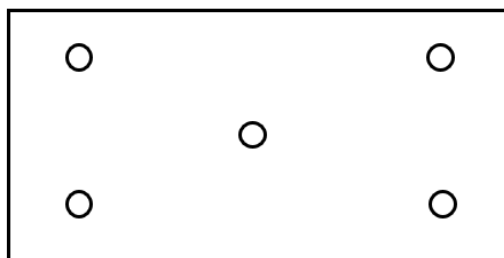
Plans de chevillage – panneaux FKD-MAX C2 (1200 x 600 mm)
